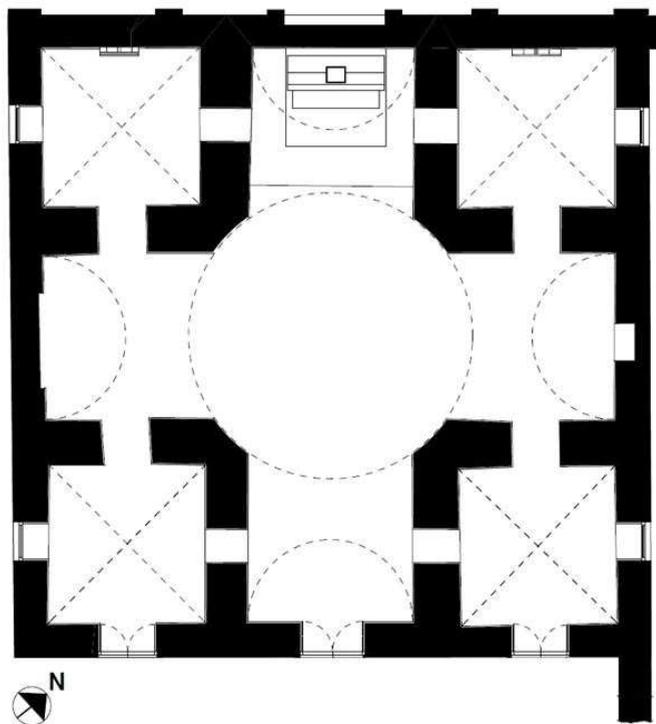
Planimetria della chiesa e sue caratterizzazioni.
